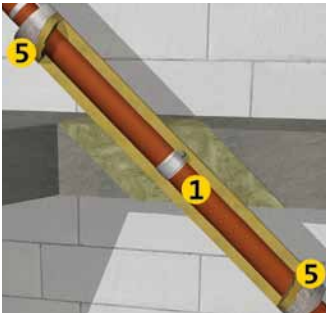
Schräg durch die Decke geführte Gussrohre (1) lassen sich ohne zeitaufwändige Zuschnitte komplett mit dem U TFA 34 Brandschutz-Filz isolieren
